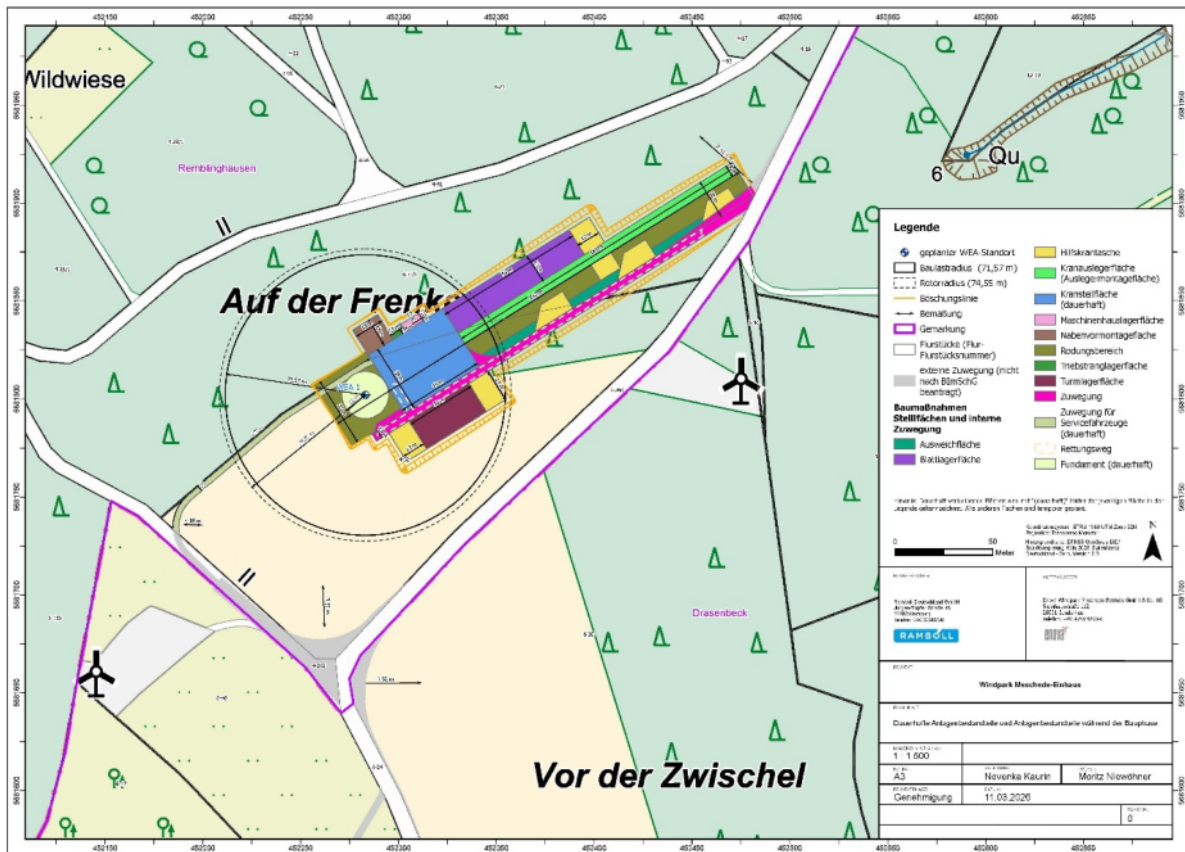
Detailansicht Baustelleneinrichtungsflächen
